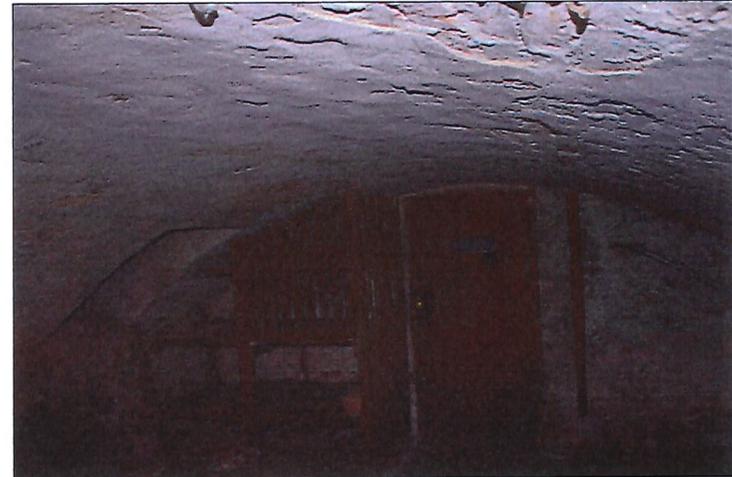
Kellerraum im Gebäude Bahnhofstraße 1
